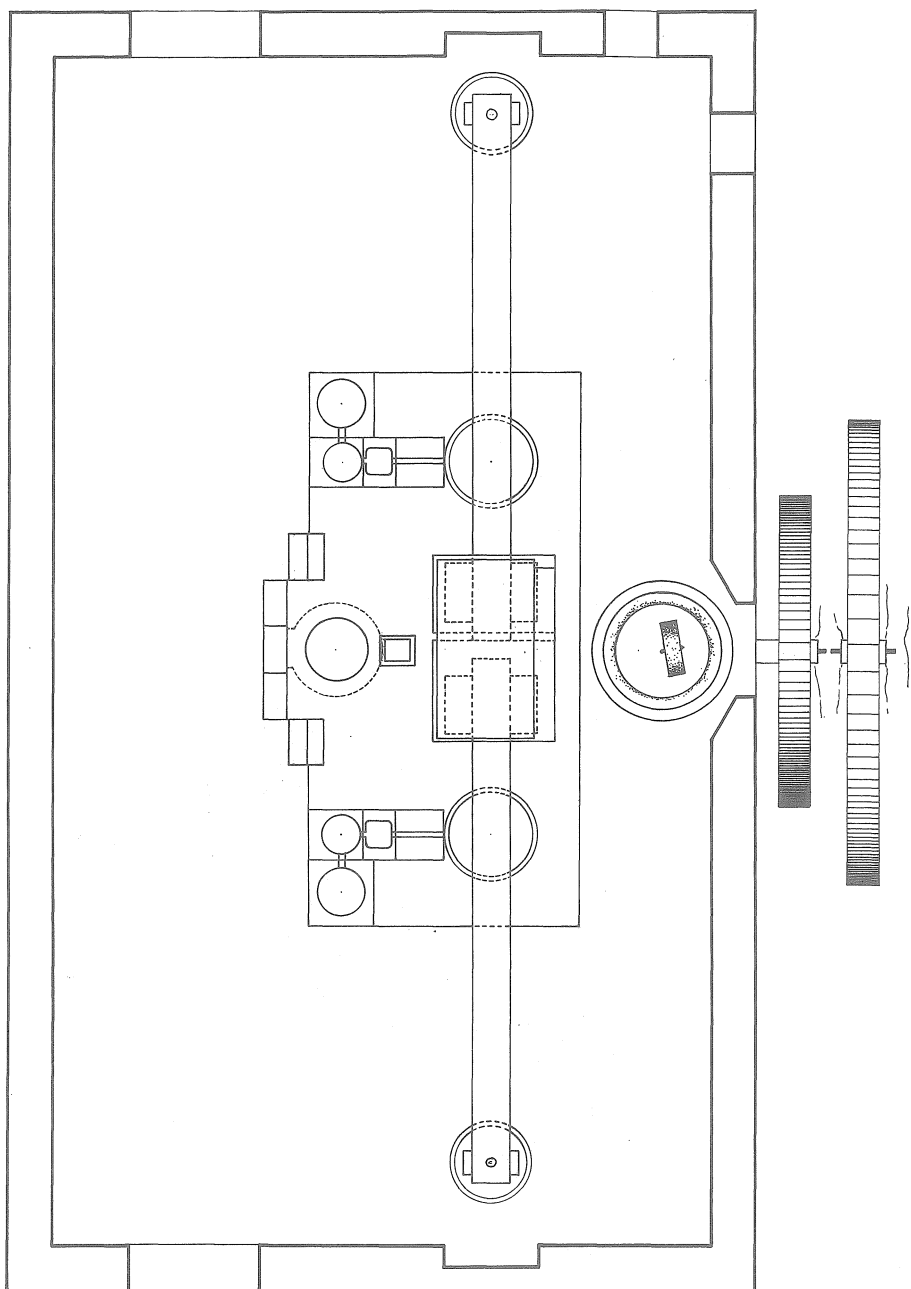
Parque, Barcelos. Planta do lagar de azeite.
